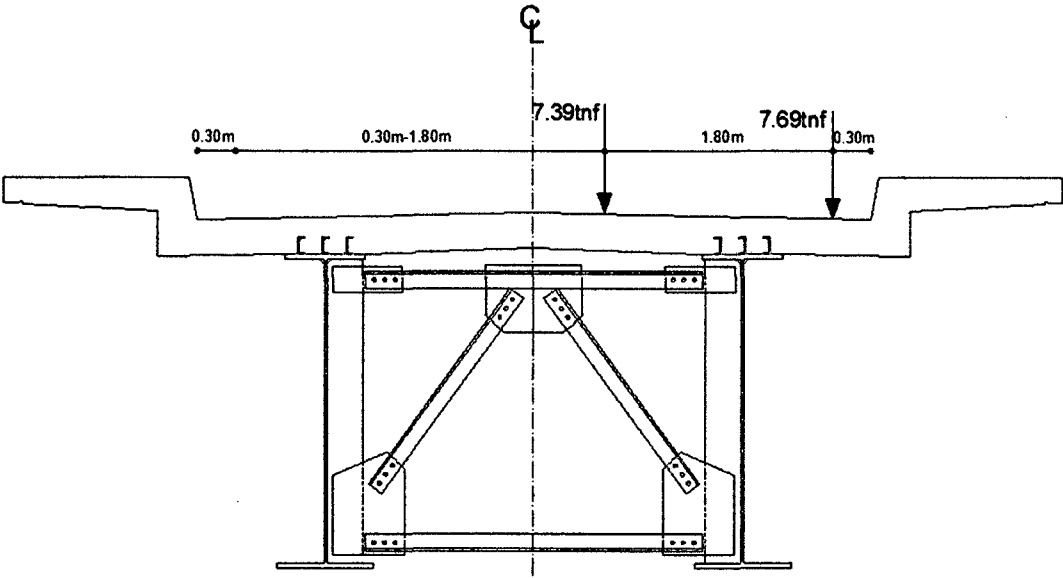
Ubicación de la Carga Móvil para el Análisis de la Losa - Para el Primer y Segundo Tramo.
